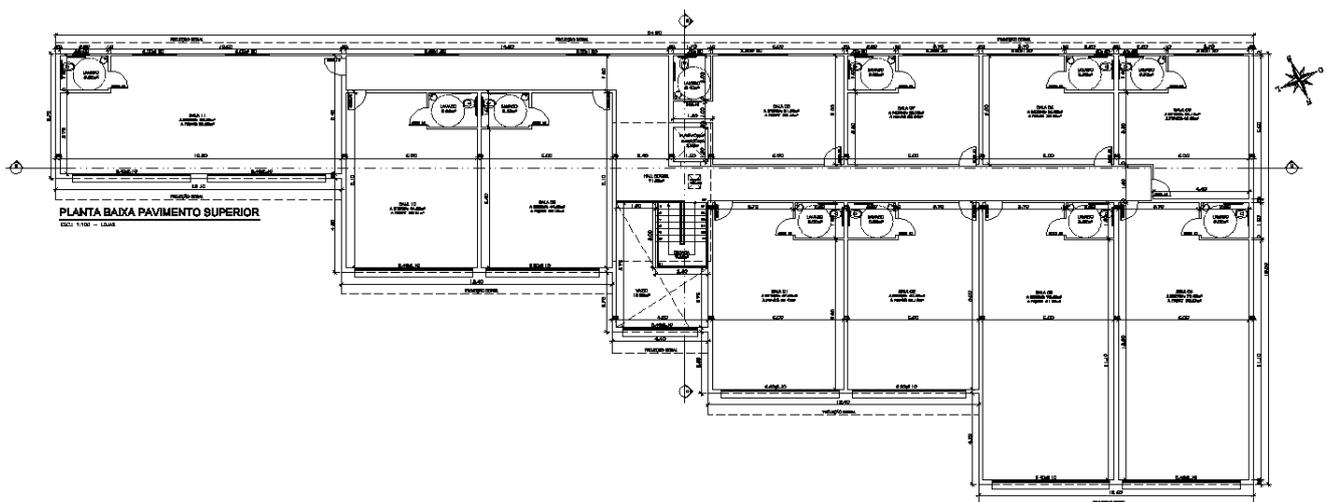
Planta Baixa Pavimento Superior - Lojas
